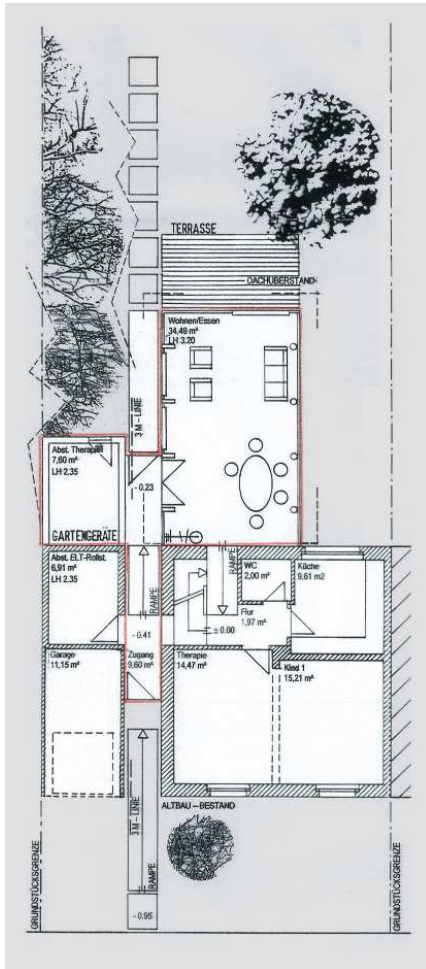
Erdgeschoss-Grundriss des umgebauten Hauses mit Anbau, Erschließungskorridor und Terrasse
